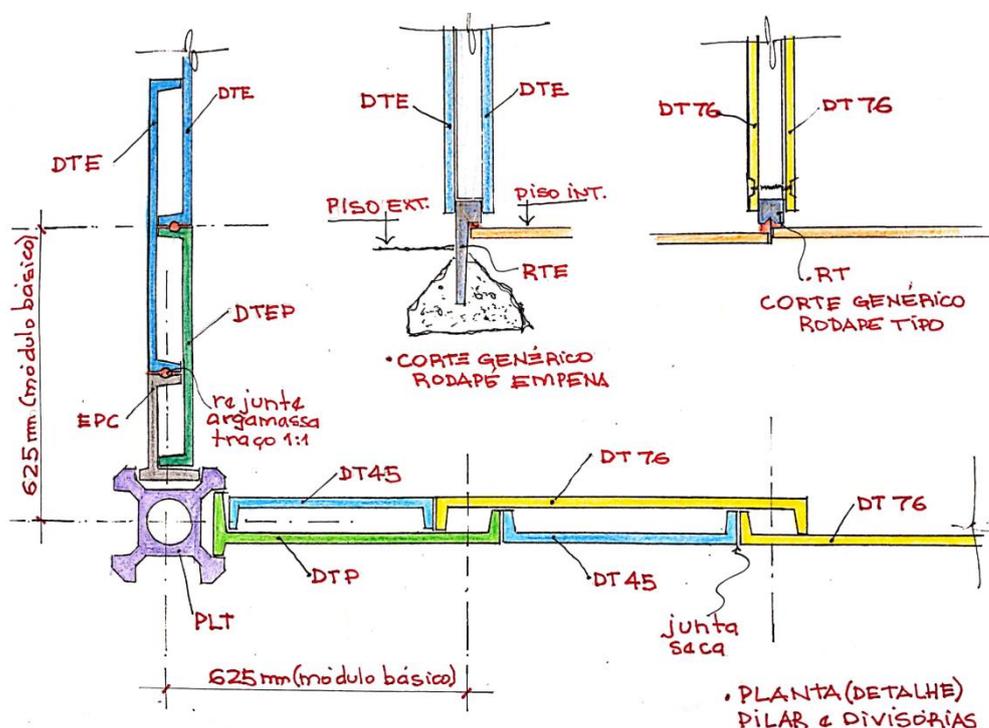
Planta mostrando a ligação do pilar entre os tipos de divisórias. Fonte: Desenho do autor.
